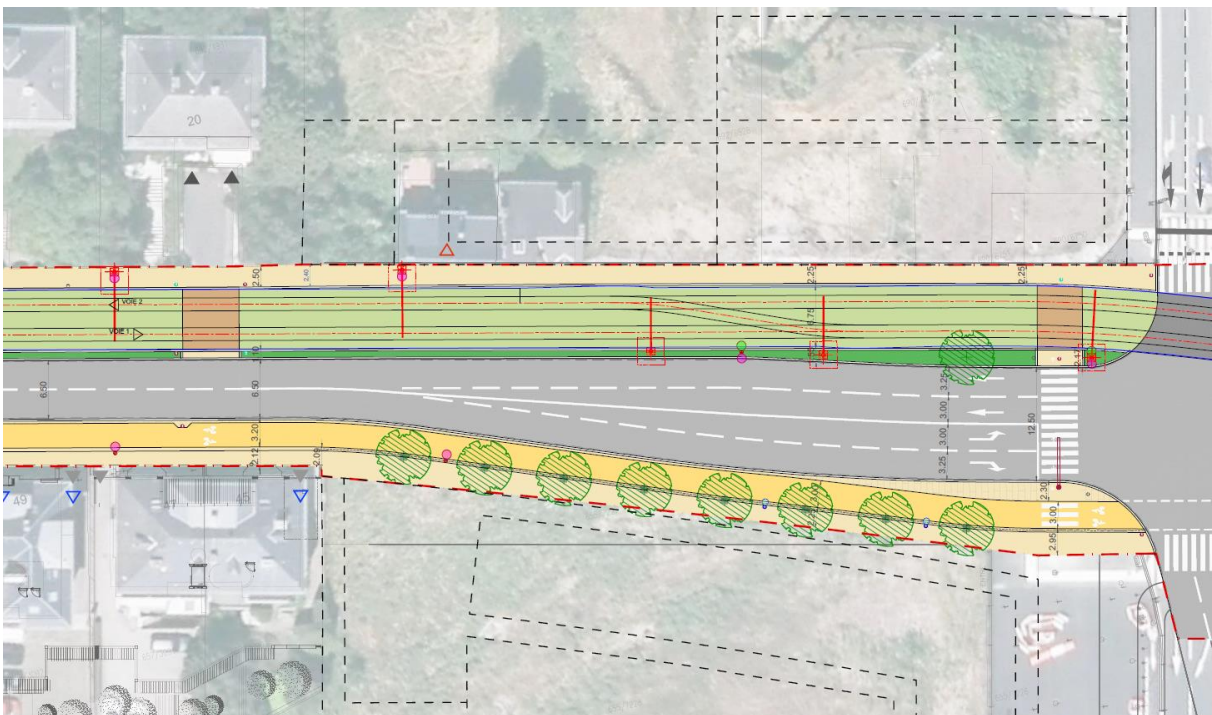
Raccordement au réseau de tramway existant au niveau de la Place de l'Etoile. Source : APS – Plans
